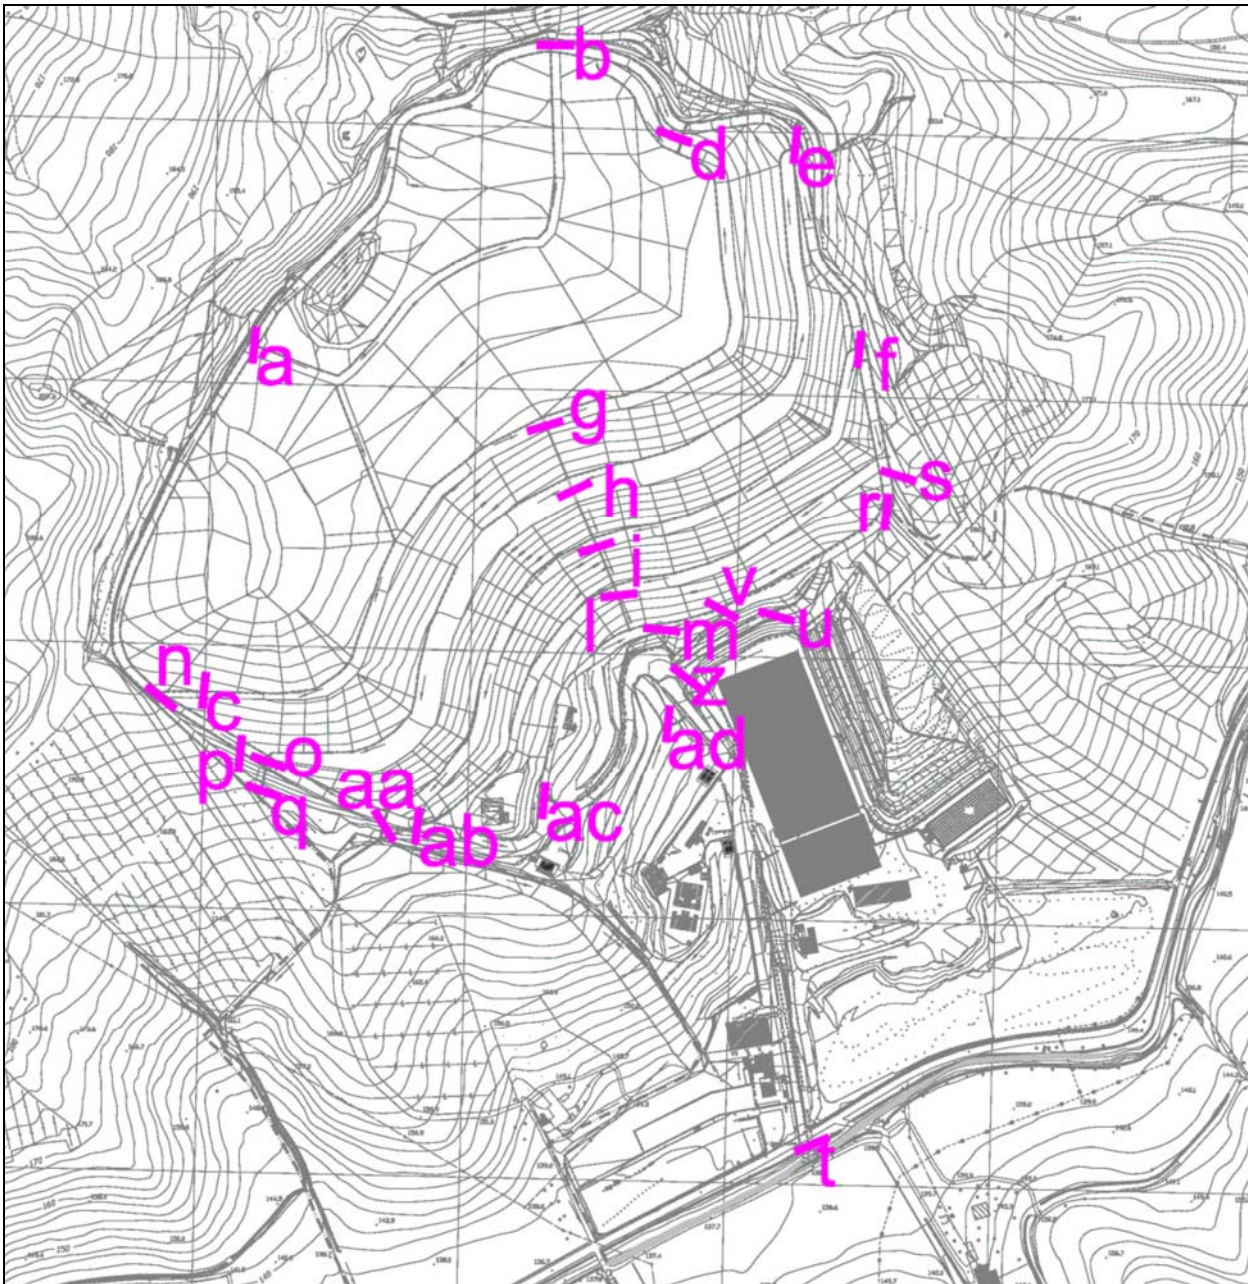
Planimetria della colmatazione generale con indicazione delle sezioni di verifica
